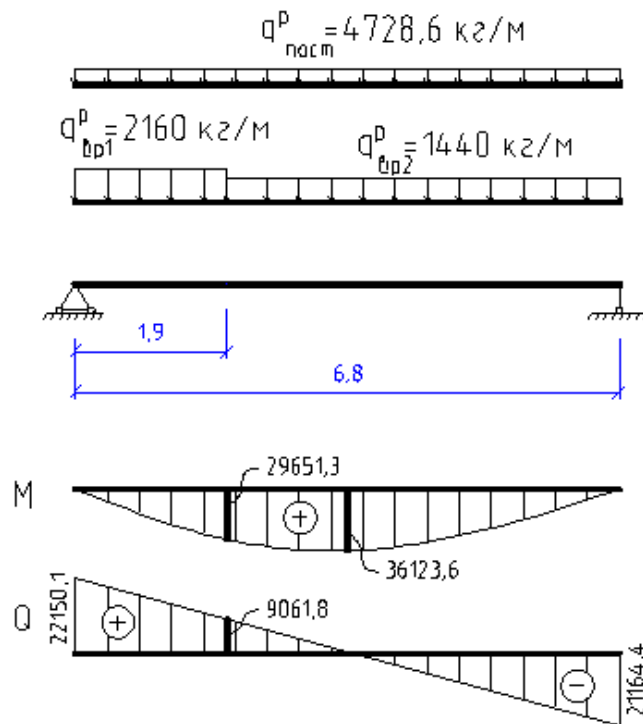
Розрахункова схема ригеля міжповерхового перекриття.
